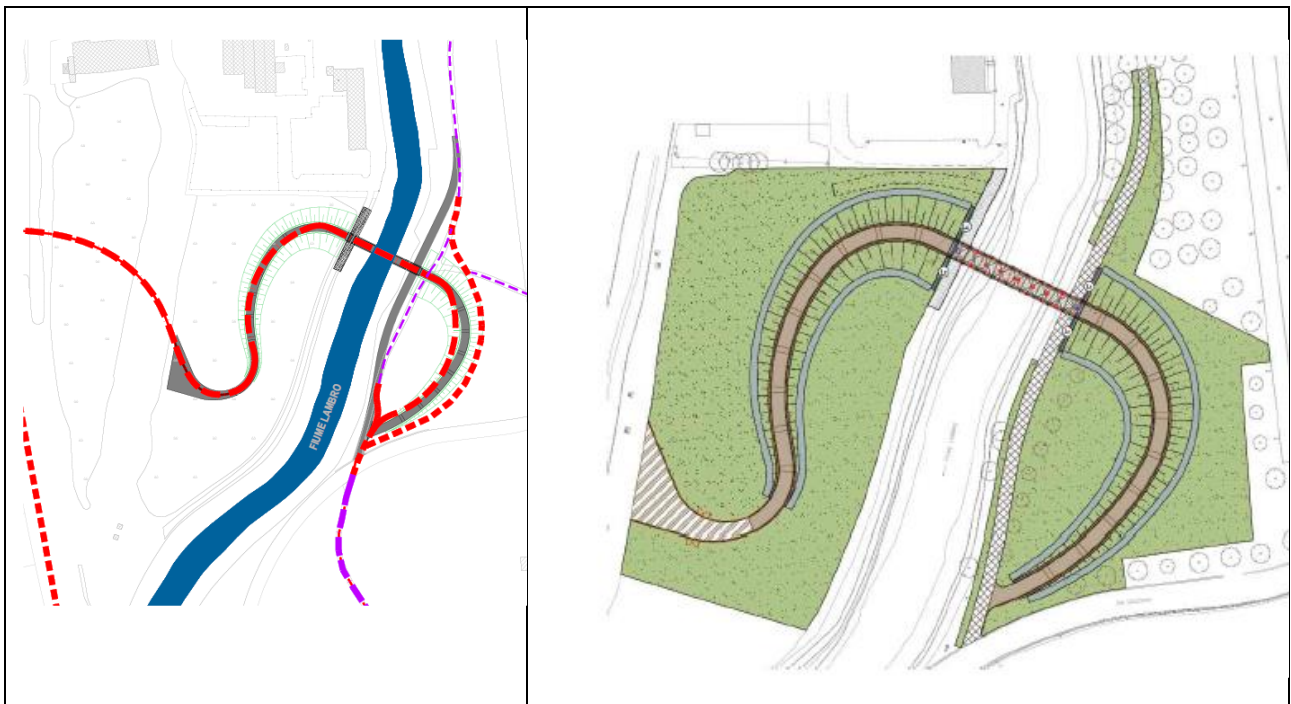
Schemi grafici in pianta dell'attraversamento ciclopedonale Forlanini (estratti dal Progetto MM)
